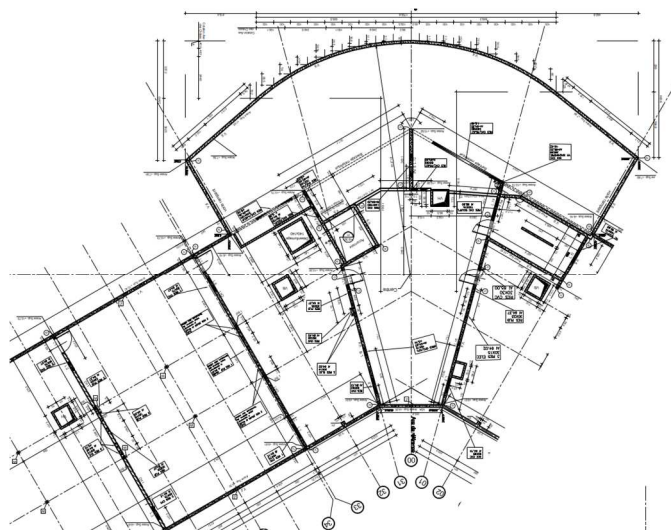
Plan Gros-Oeuvre des combles, bâtiment MA1, DOE
